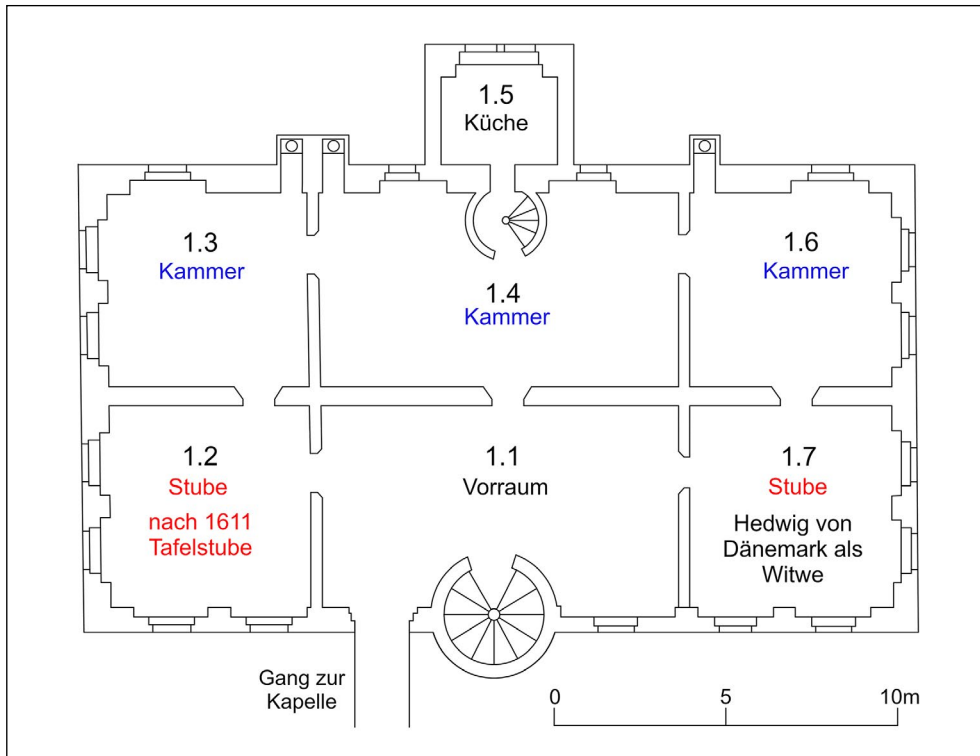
Jessen (Elster), Schloss Glücksburg, erstes Obergeschoss, Grundriss, Rekonstruktion des Baubestands und der Raumstruktur 1611–1641
